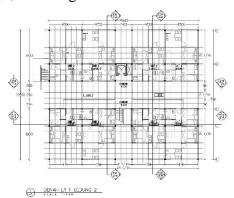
16. Denah Lt.1, 2, 3 Gedung 1
